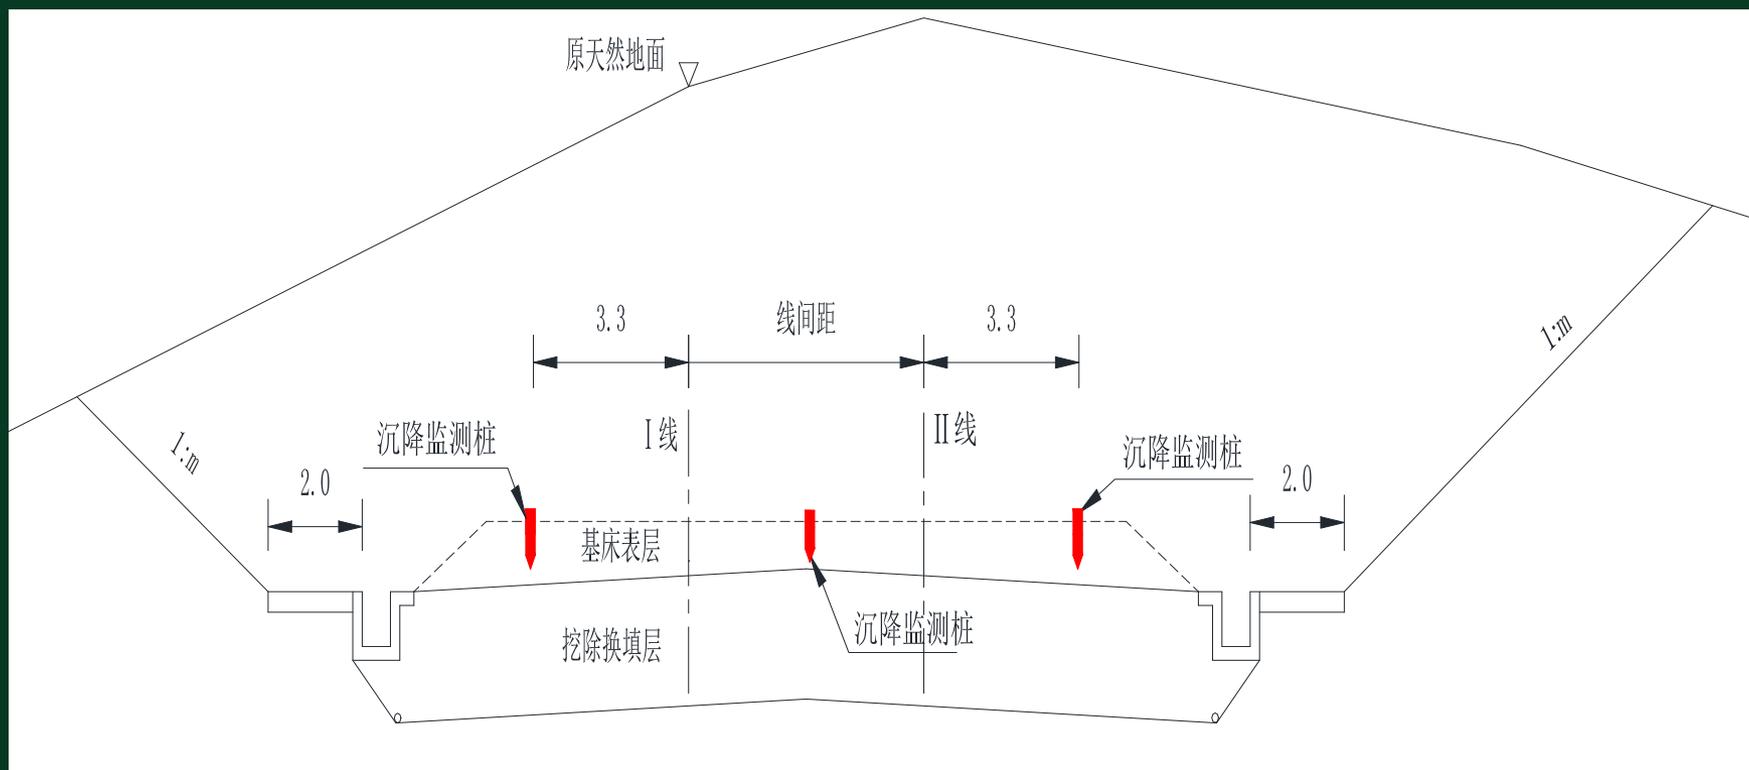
12一般路堑地段沉降监测剖面元件布置示意图（单位：m）
